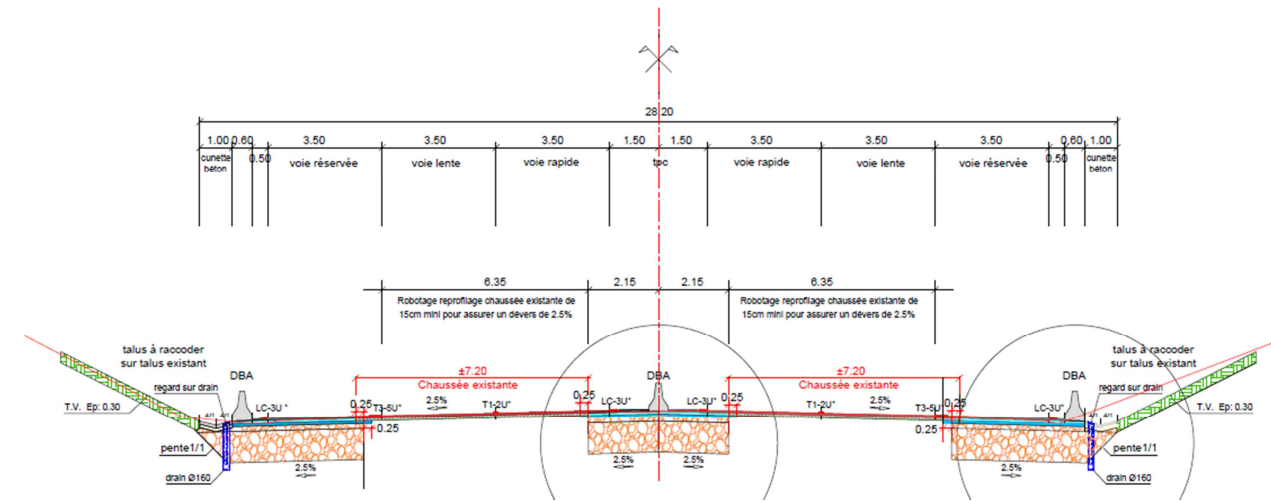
profil en travers type de l'A351 (pas d'élargissement mais BAU reprises afin de supporter la circulation de cars)
